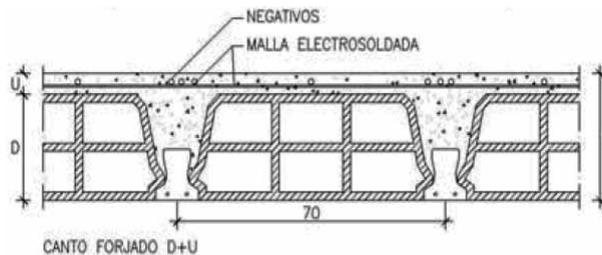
Forjado de semiviguetas pretensadas. Sección transversal con semiviguetas pretensadas y bovedillas.
